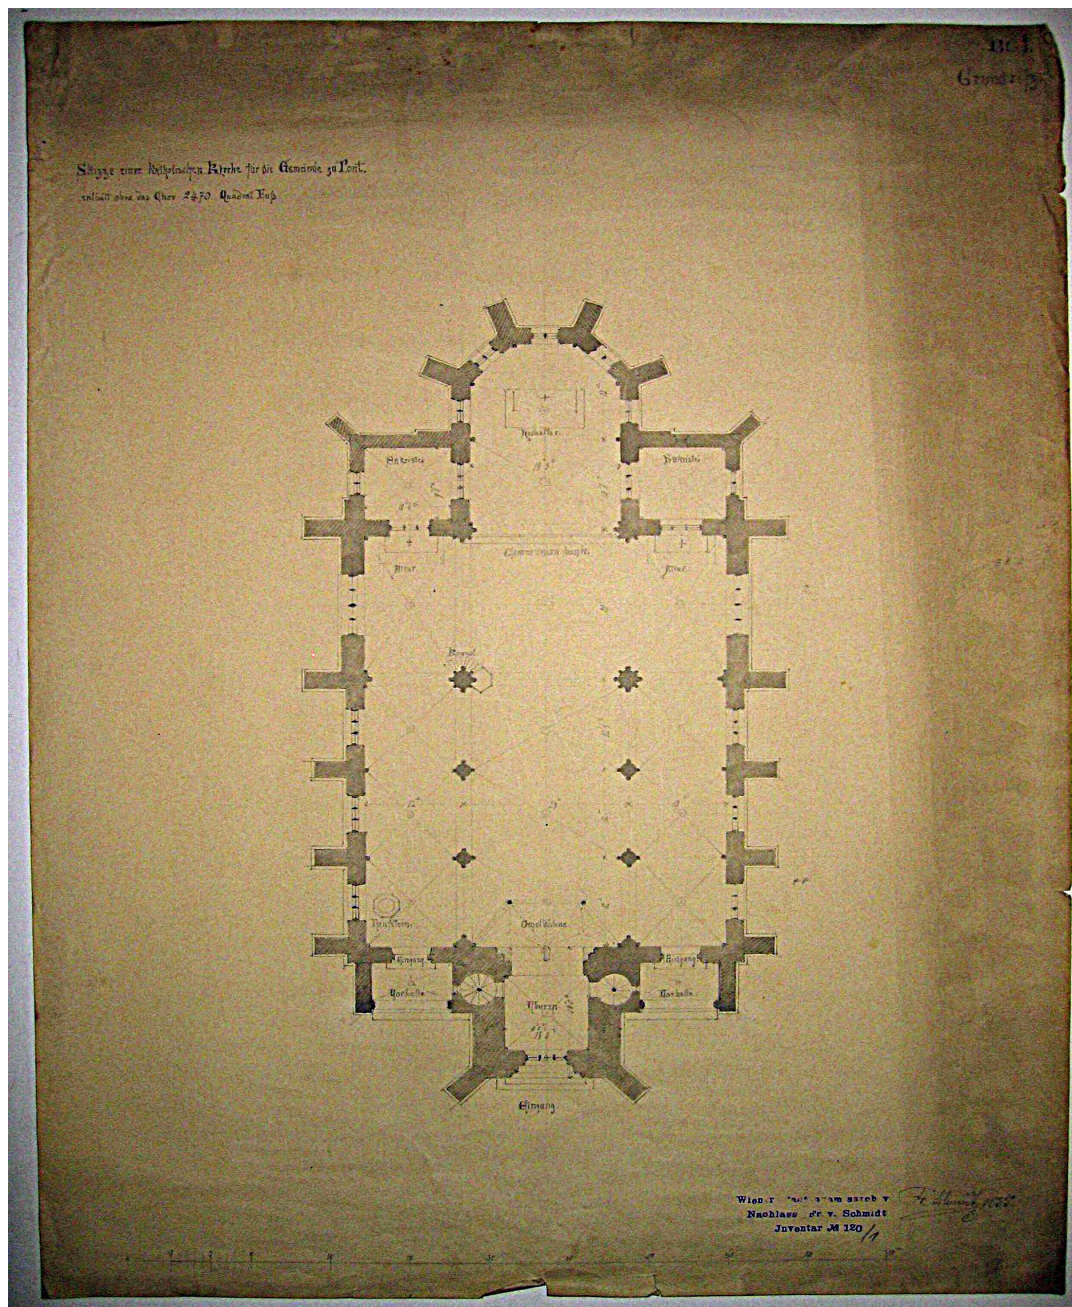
WM, Inv.-Nr. 157.120/1 Grundriss
